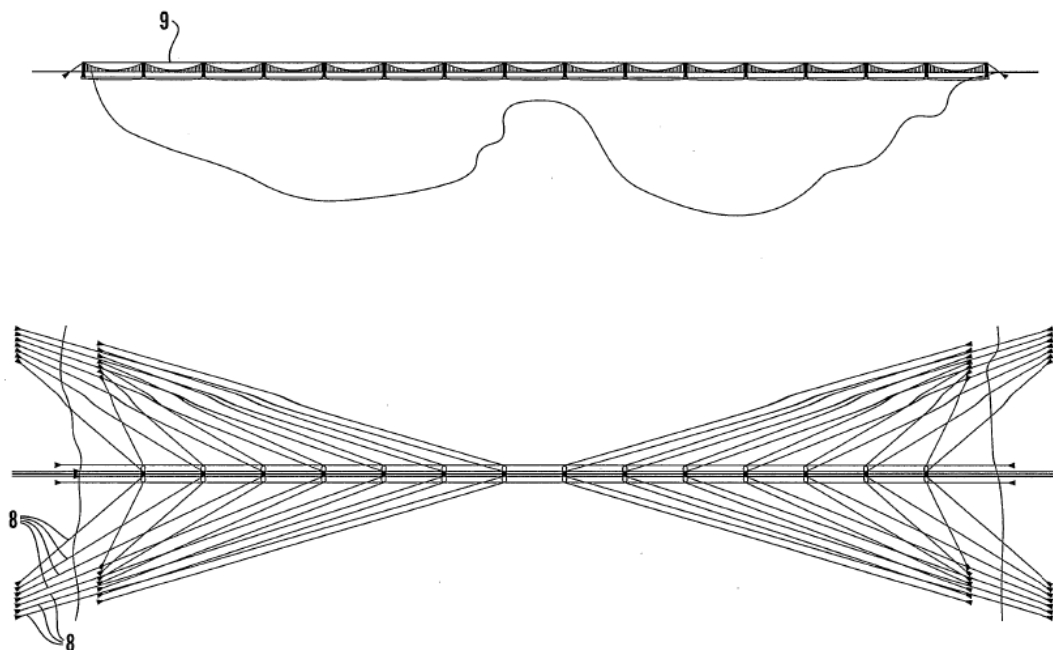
Ansicht und Grundriss, Variante 1c (Aardal, 2005)
